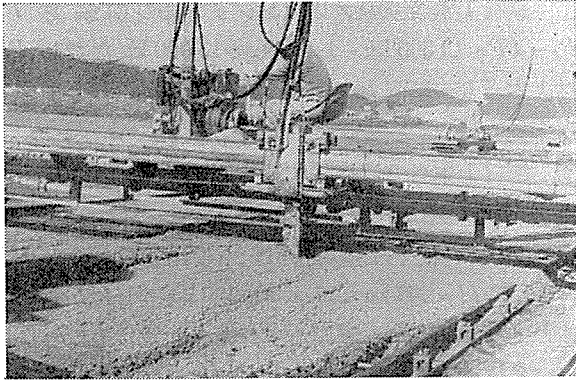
ブレード型スプレッダーによるコンクリート舗設状況
